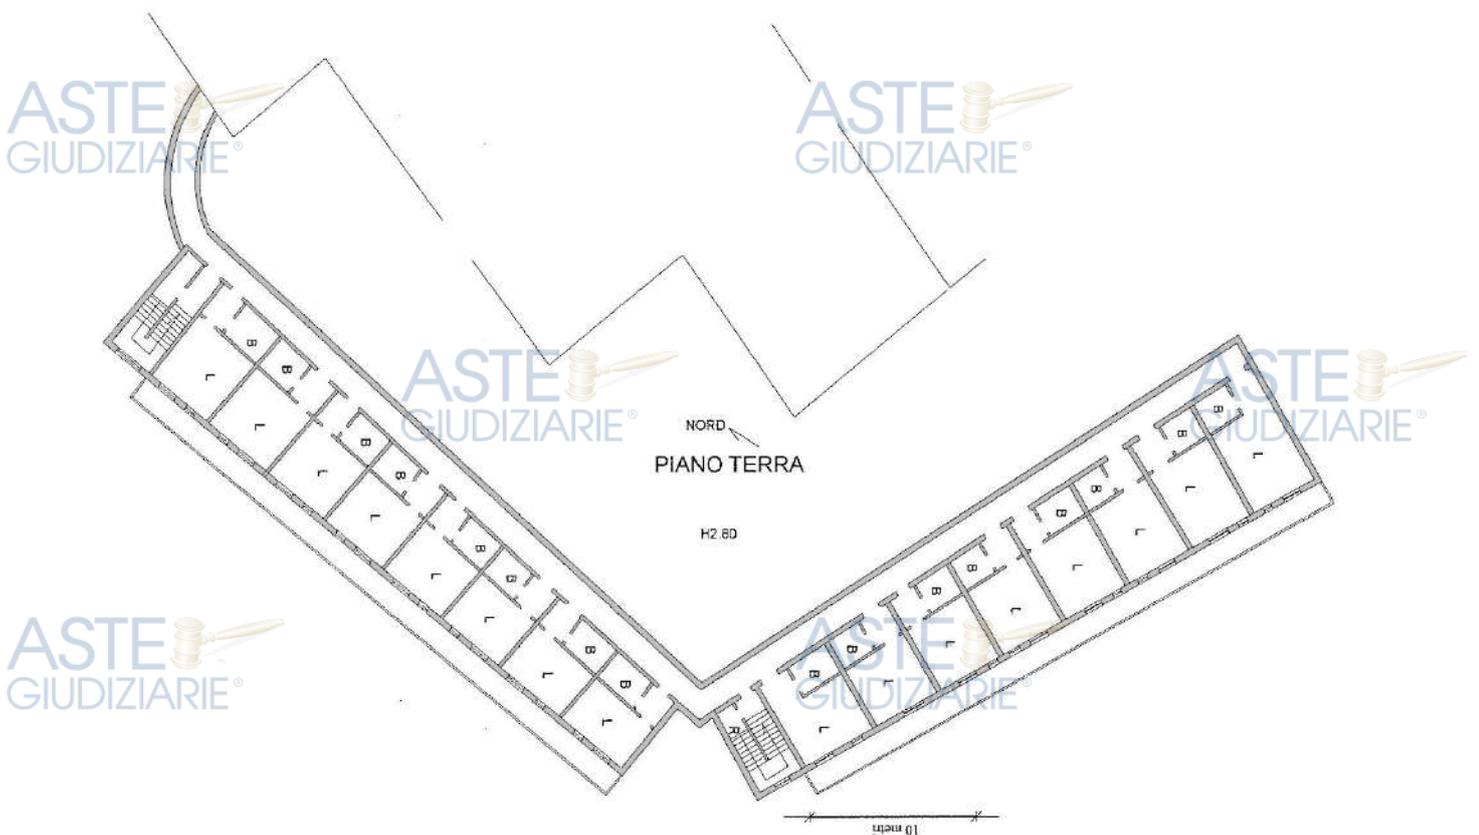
Lotto 1. Corpo D. Planimetria piano terra.
